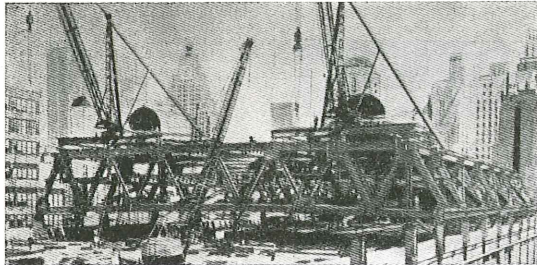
Vigas Warren, en celosía, de 60,8 m de luz y 7,8 m de canto, para una estación terminal de autobuses en Nueva York. Las vigas van colocadas a 15,25 m entre ejes y sustentan tres plantas situadas, dos en los cordones superior e inferior y otra a la mitad del canto, colgada de los nudos superiores.
